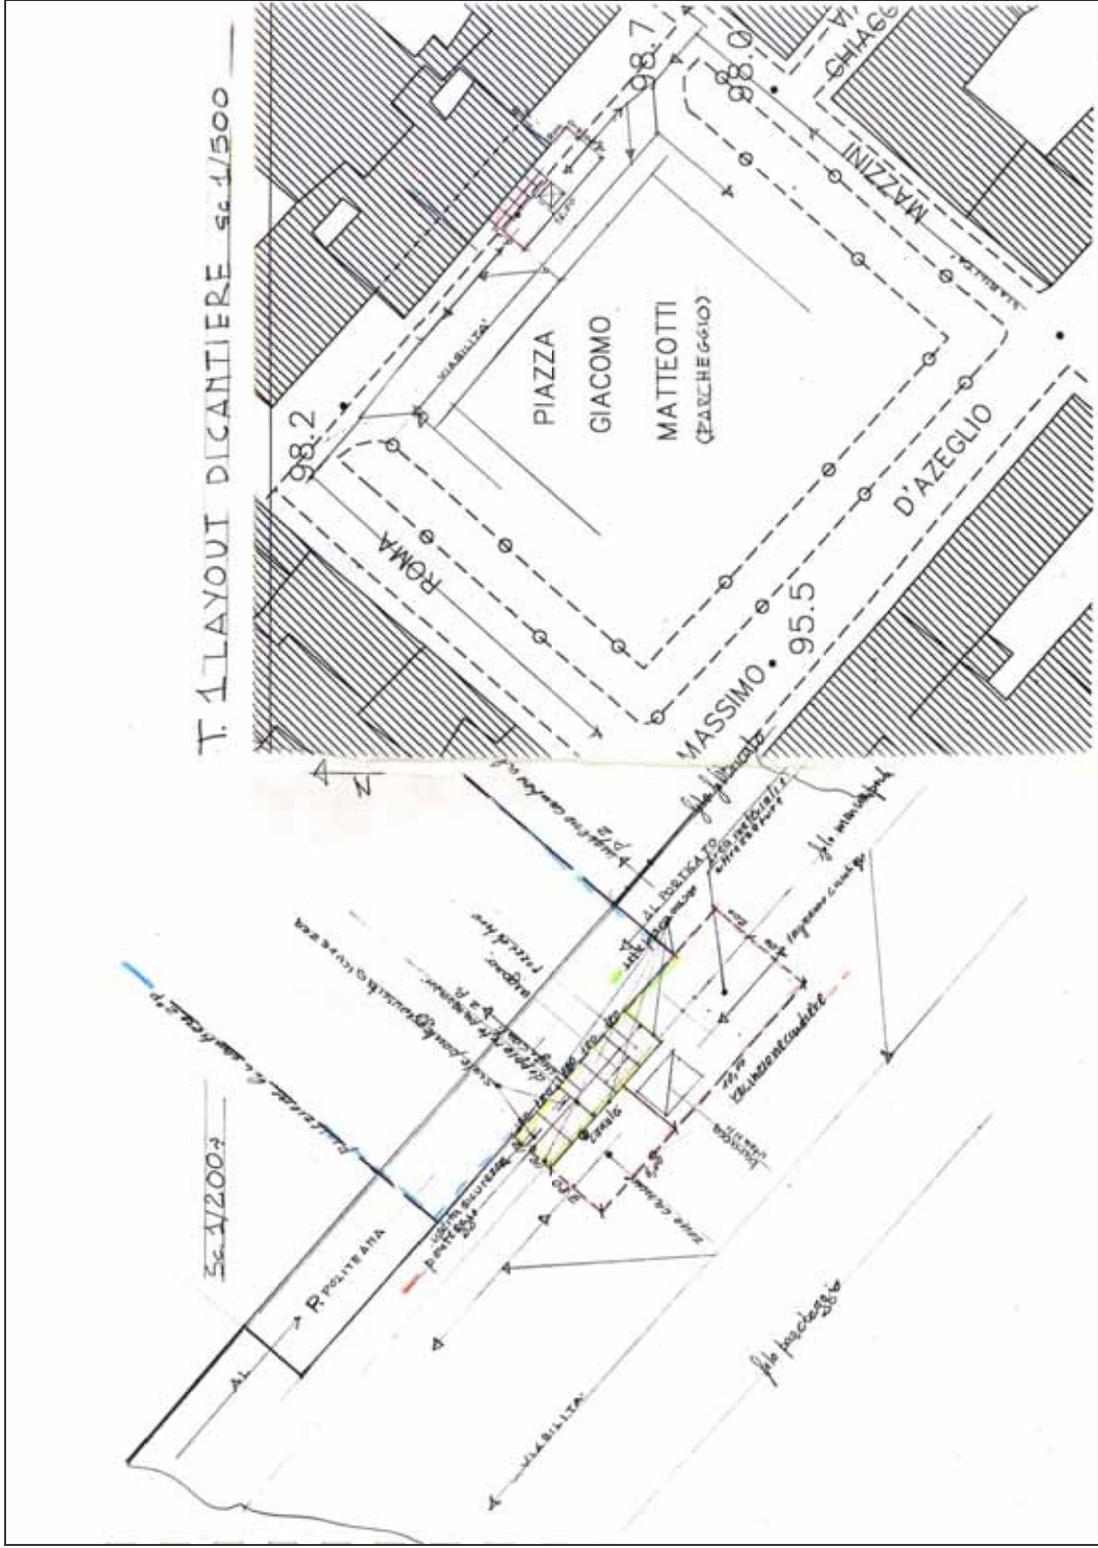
Localizzazione del cantiere esterno del “Salone Germinal”, piantina, Archivio Privato Arch. Gemignani, Carrara
